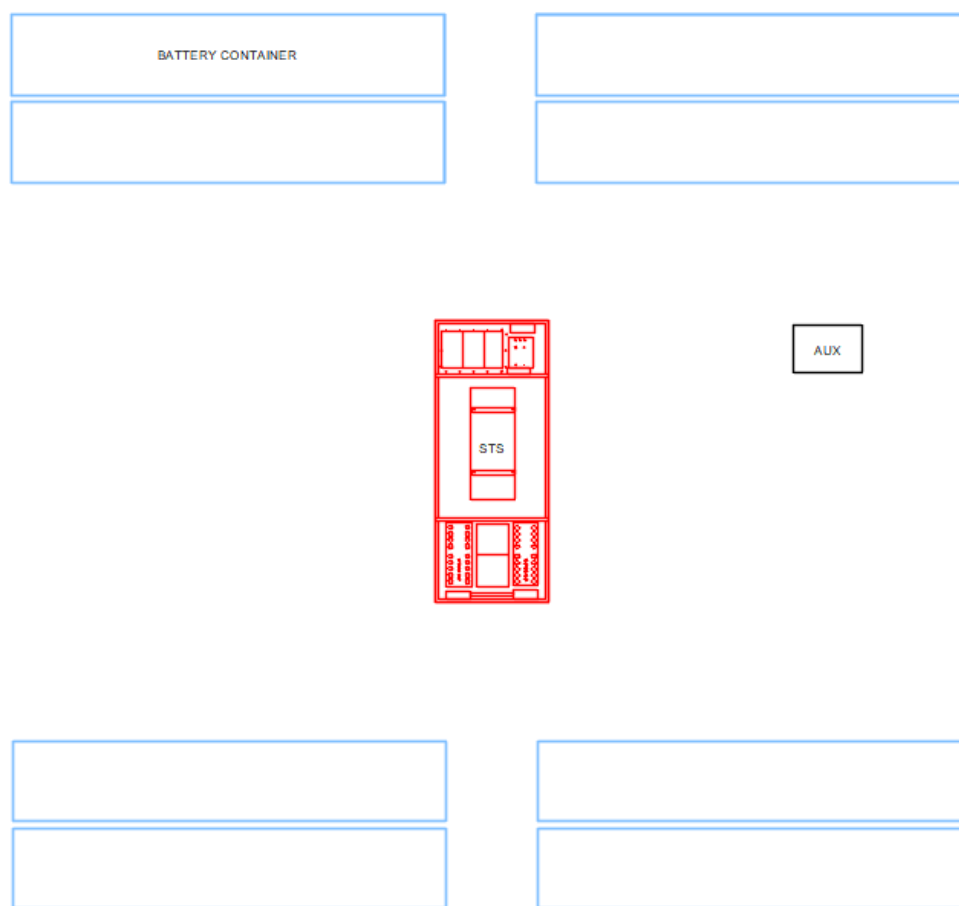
Layout tipico di una unità di accumulo da 3,00 MW
